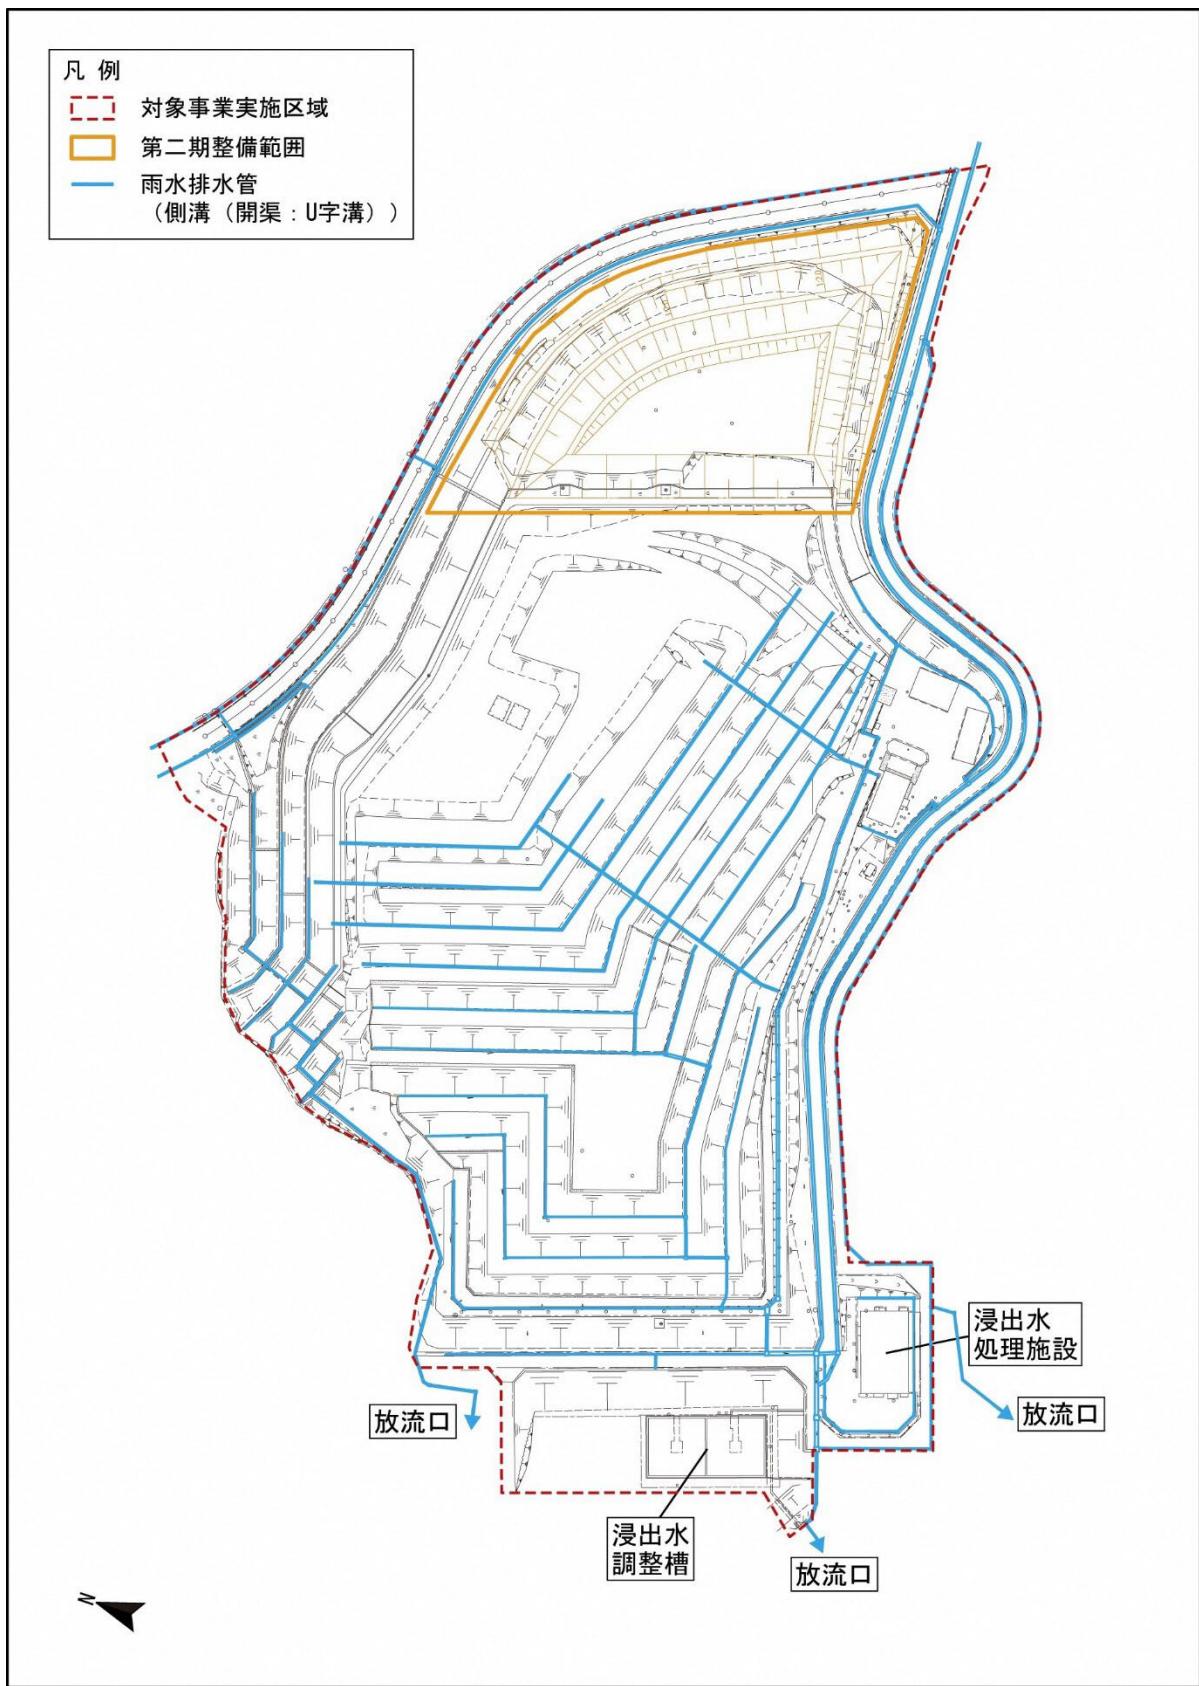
(2) 集排水設備計画平面図（雨水等集排水設備）
